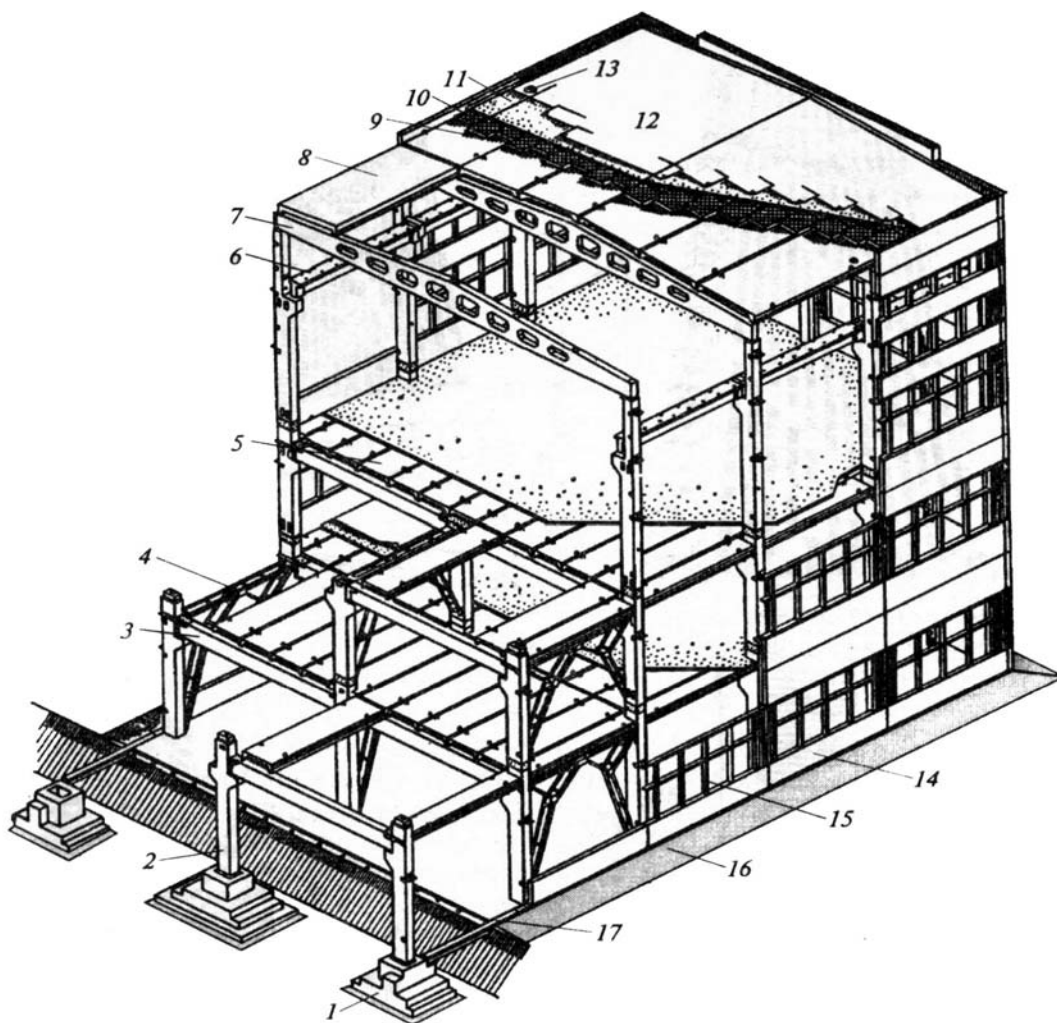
Основные элементы многоэтажного здания с рамно-связевым железобетонным каркасом:
